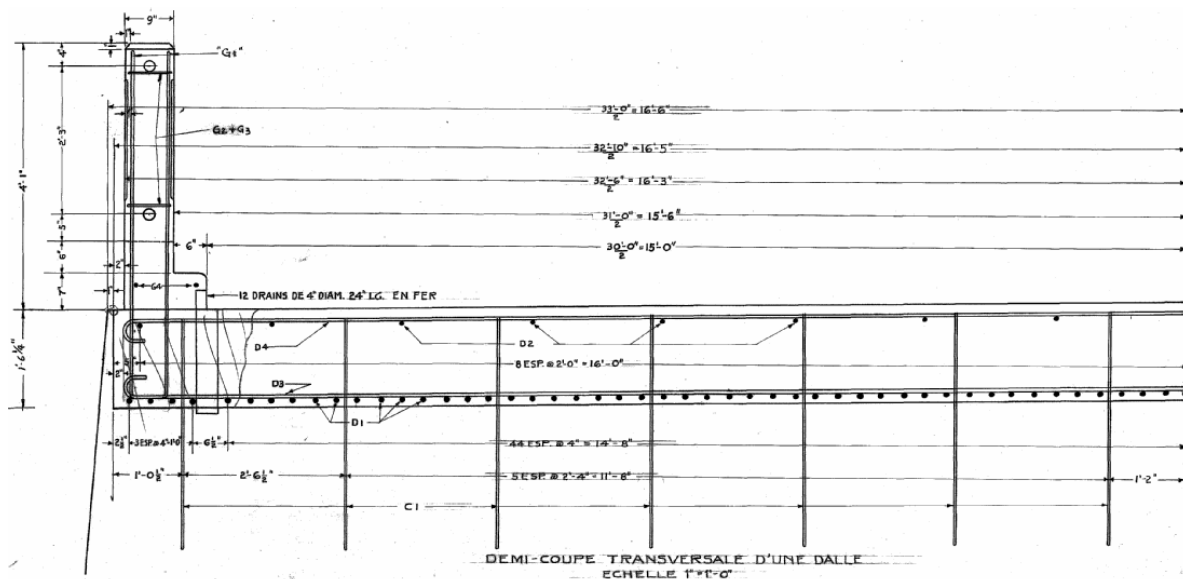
Demi-coupe transversale (plans d'origine [5])
